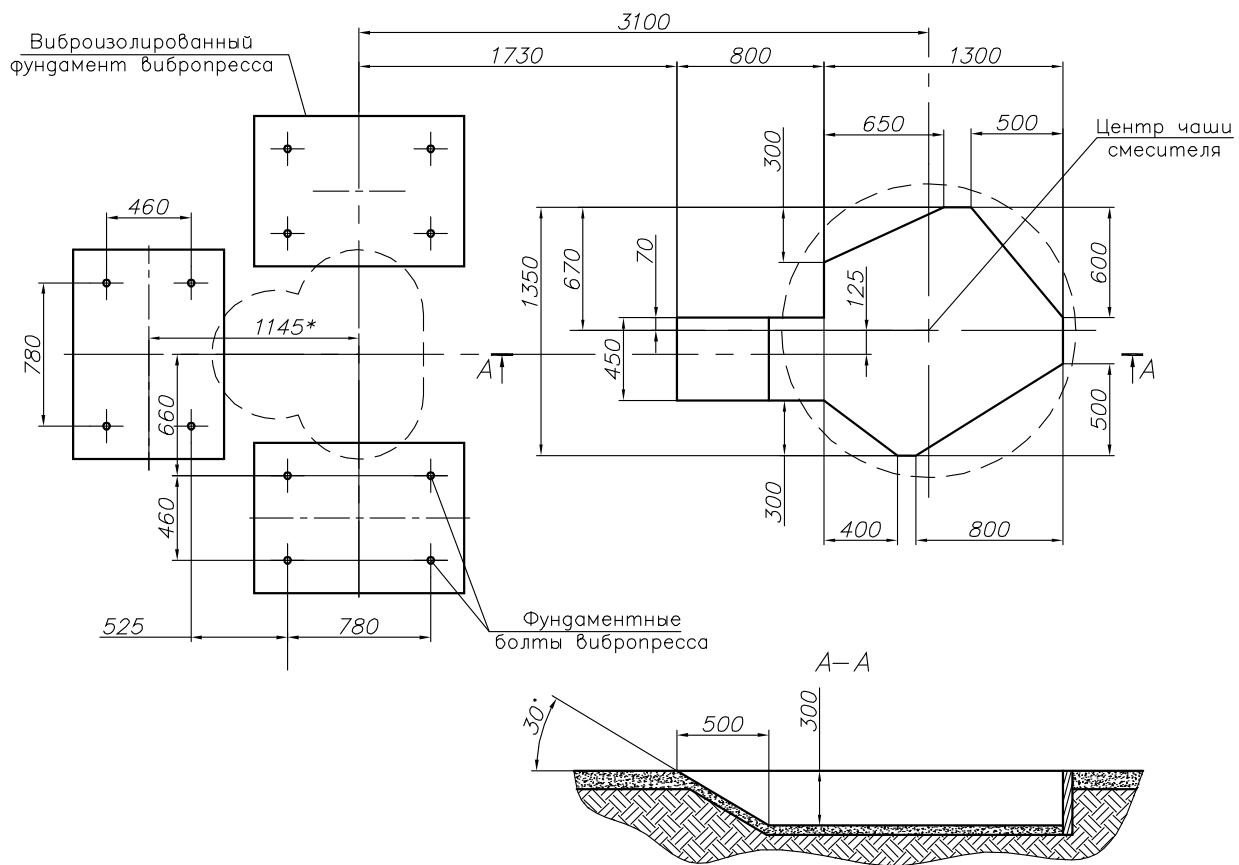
Схема установки вибропрессов, бункера и смесителя в приямке.
